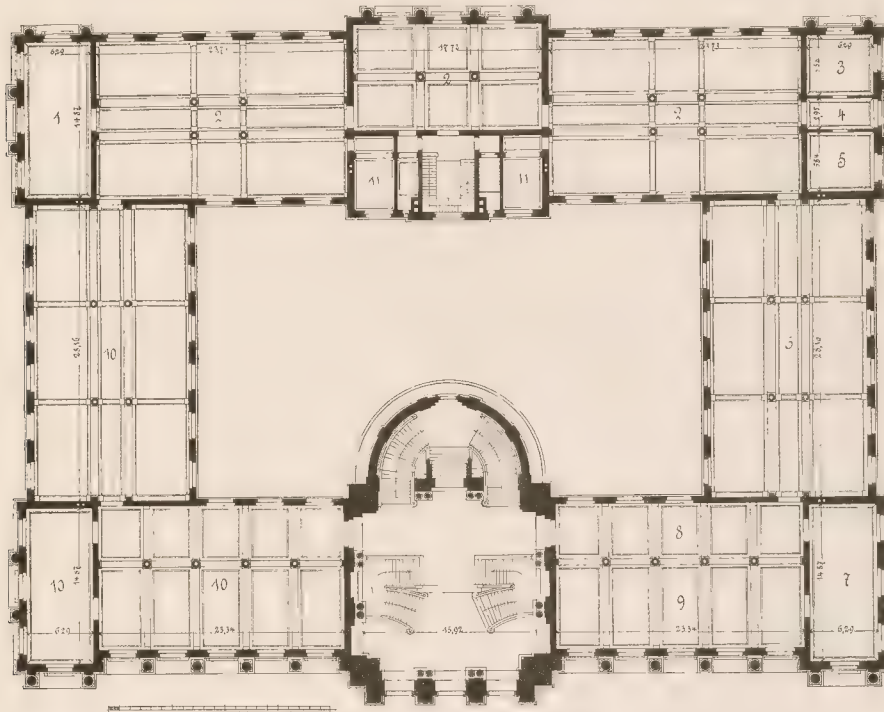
Grundriss des Hauptgeschosses.
